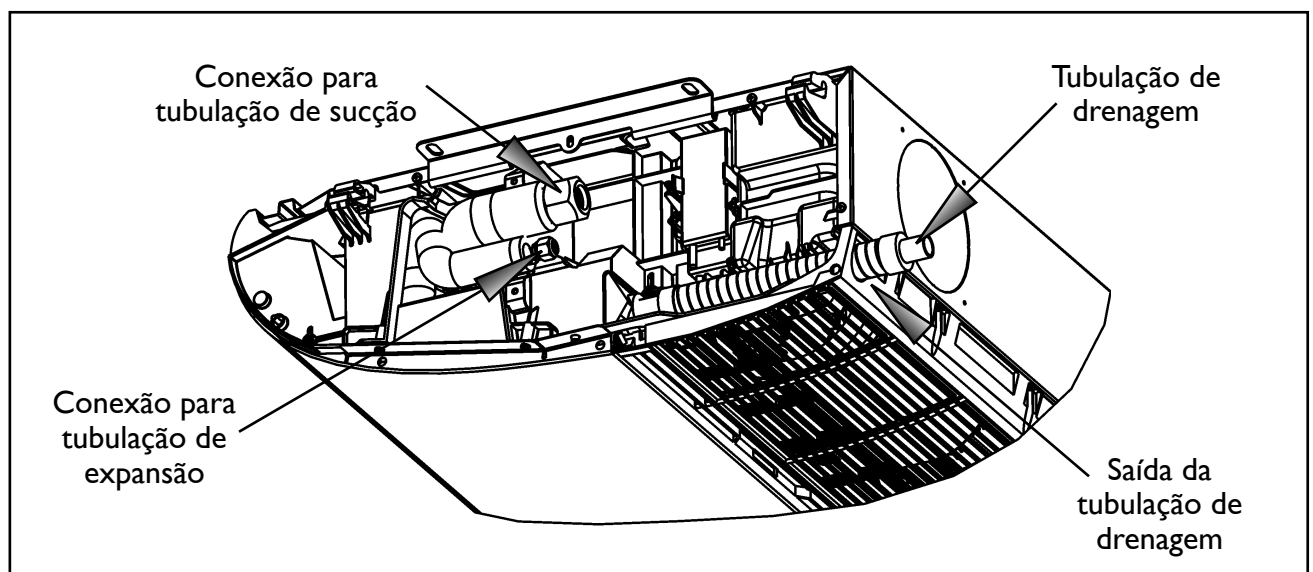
TUBULAÇÕES DE DRENO MONTAGEM TETO
